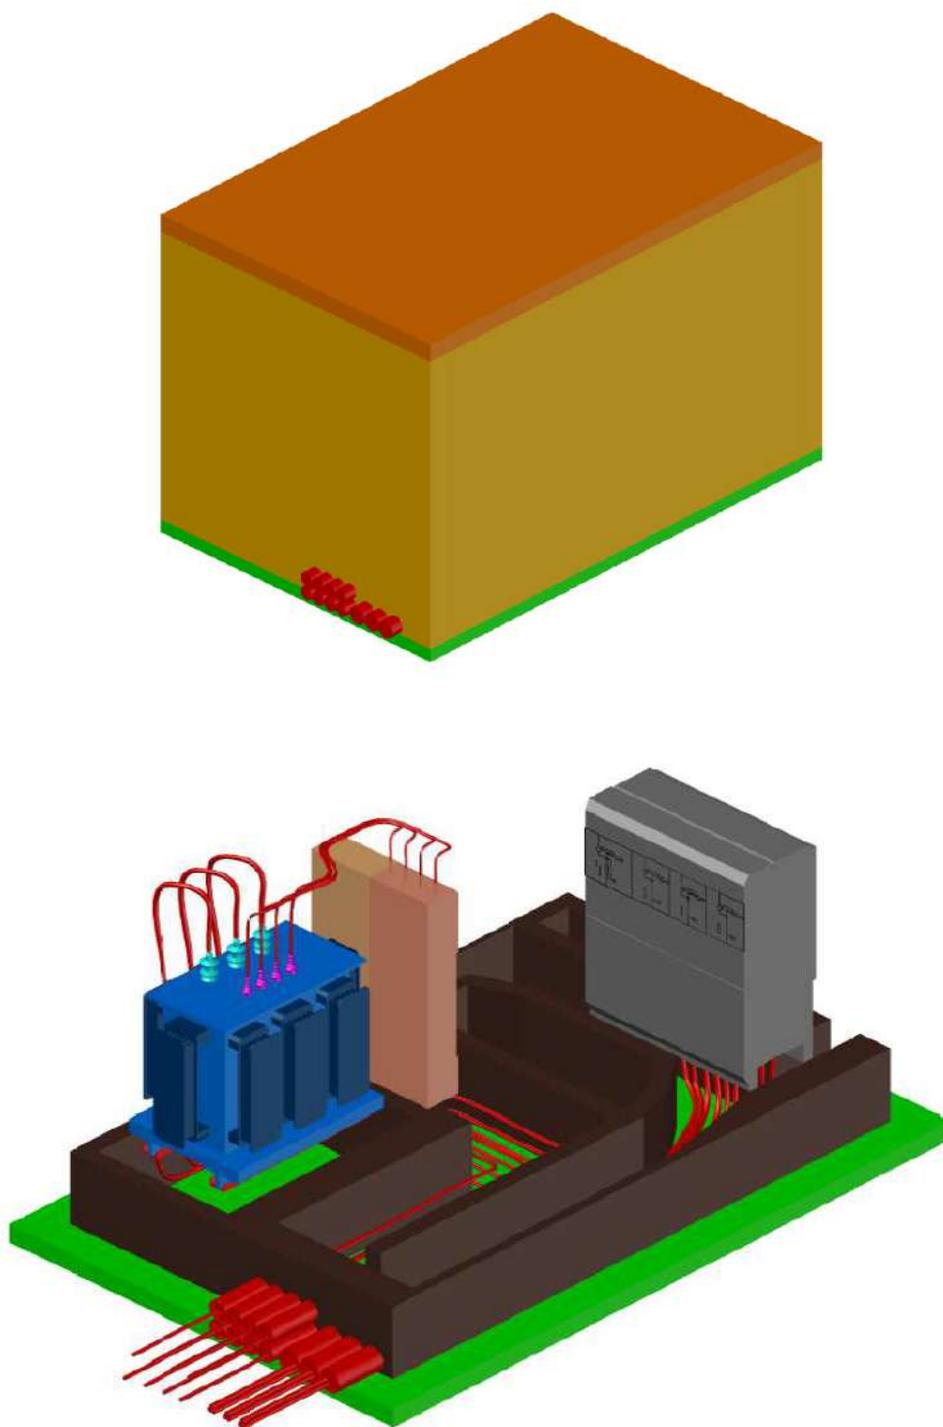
Vistas 3D del centro de transformación tipo en edificio con fachada estrecha
